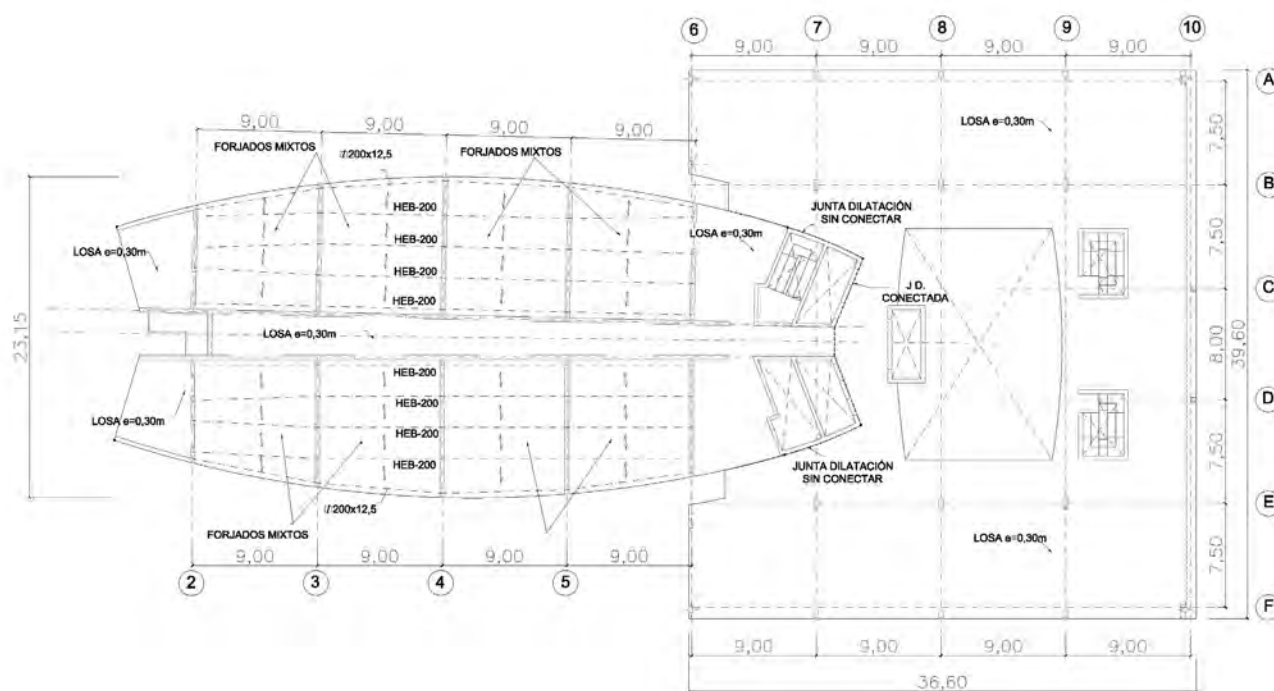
Planta tipo entre P-1 y P-7 con los edificios Torre y Atrio del Hotel Vela.
